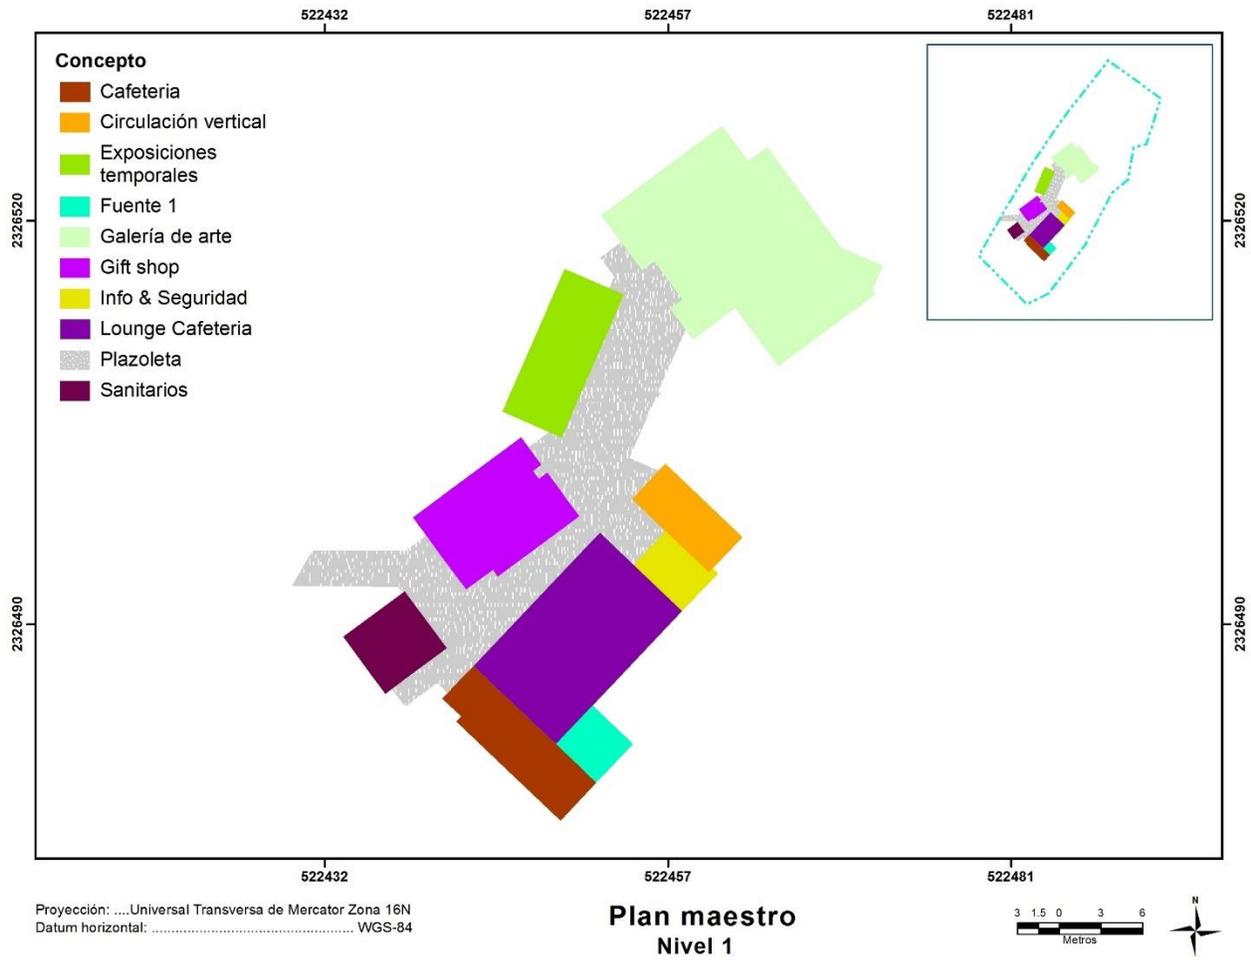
14. Planta Arquitectónica Primer Nivel.
